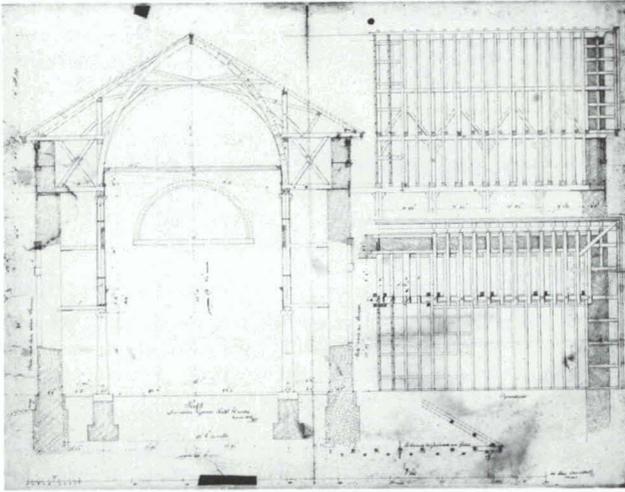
Detailzeichnung Mollers von 1815 für die Dach- und Deckenkonstruktion der Stadtkirche, Federzeichnung auf Papier 660 : 514 mm, Wasserzeichen: C & I HONIG, Hochbaumt
